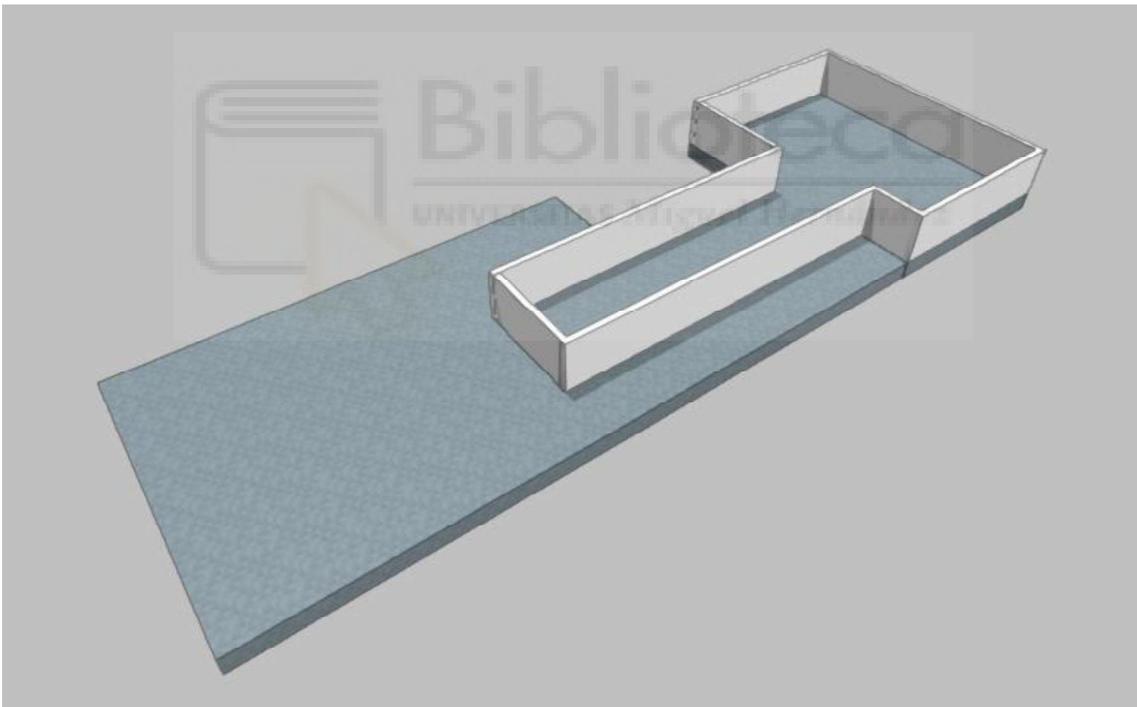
Distribución Planta Cubierta. Vista: En 3D. IFC Builder
